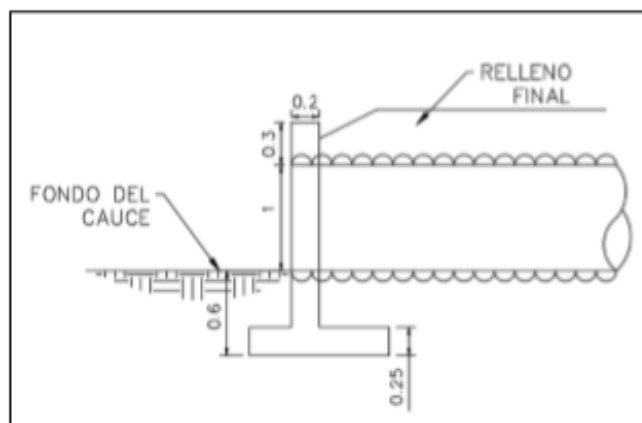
Corte transversal muro boca y tubo PAD Estero 3
